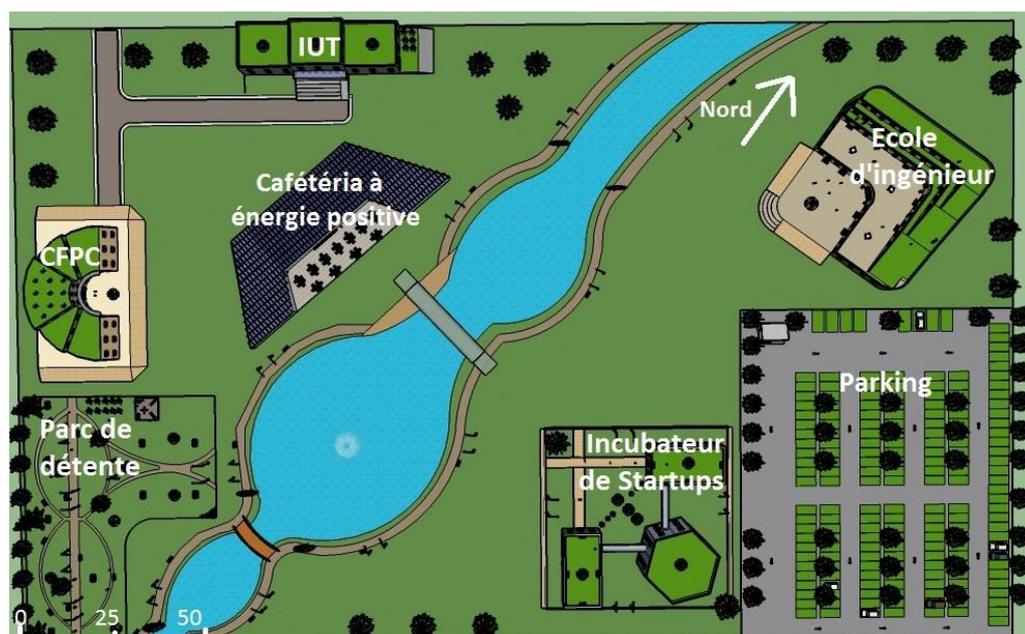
Plan général du projet (modélisé sur Sketchup)
